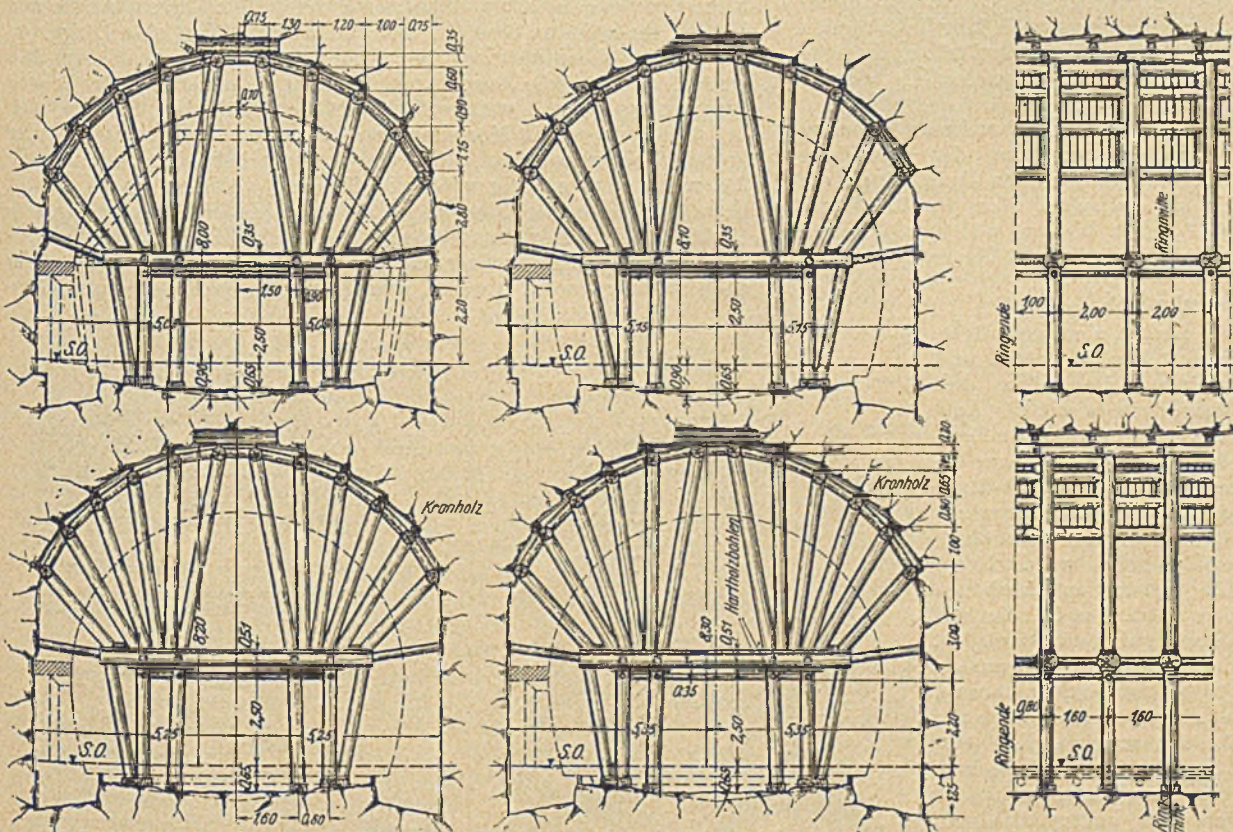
Die Auszimmerung der 4 Tunnel-Querschnitte mit dem Schwellenbau. Bogenstuhl mit Lehrbogen und Verstärkung.
